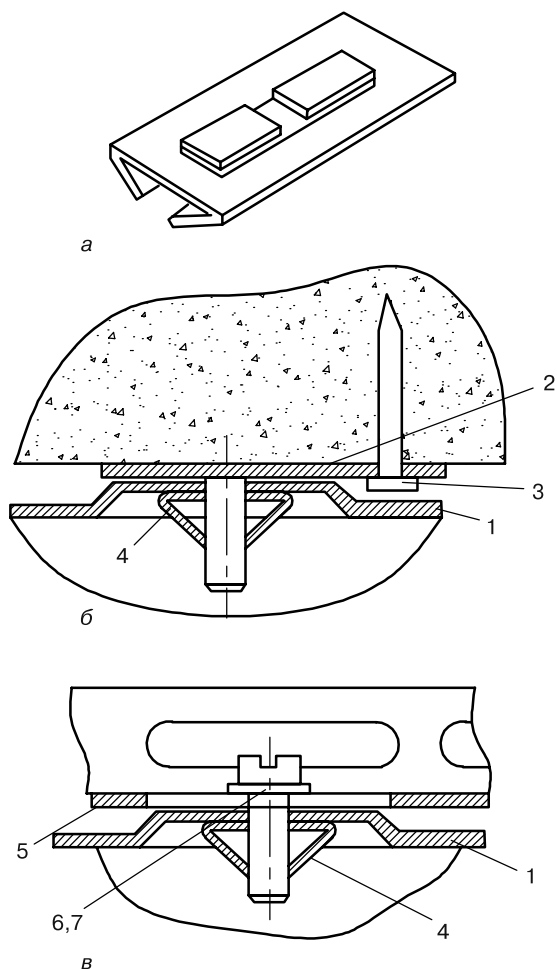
Крепление люминесцентных светильников: *а* — конструкция для безметизного крепления; *б* — крепление к опорной поверхности; *в* — крепление к монтажному профилю; 1 — светильник люминесцентный; 2 — планка с резьбовой шпилькой; 3 — дюбель-гвоздь; 4 — конструкция для безметизного крепления светильников; 5 — профиль монтажный; 6, 7 — винт с шайбой
